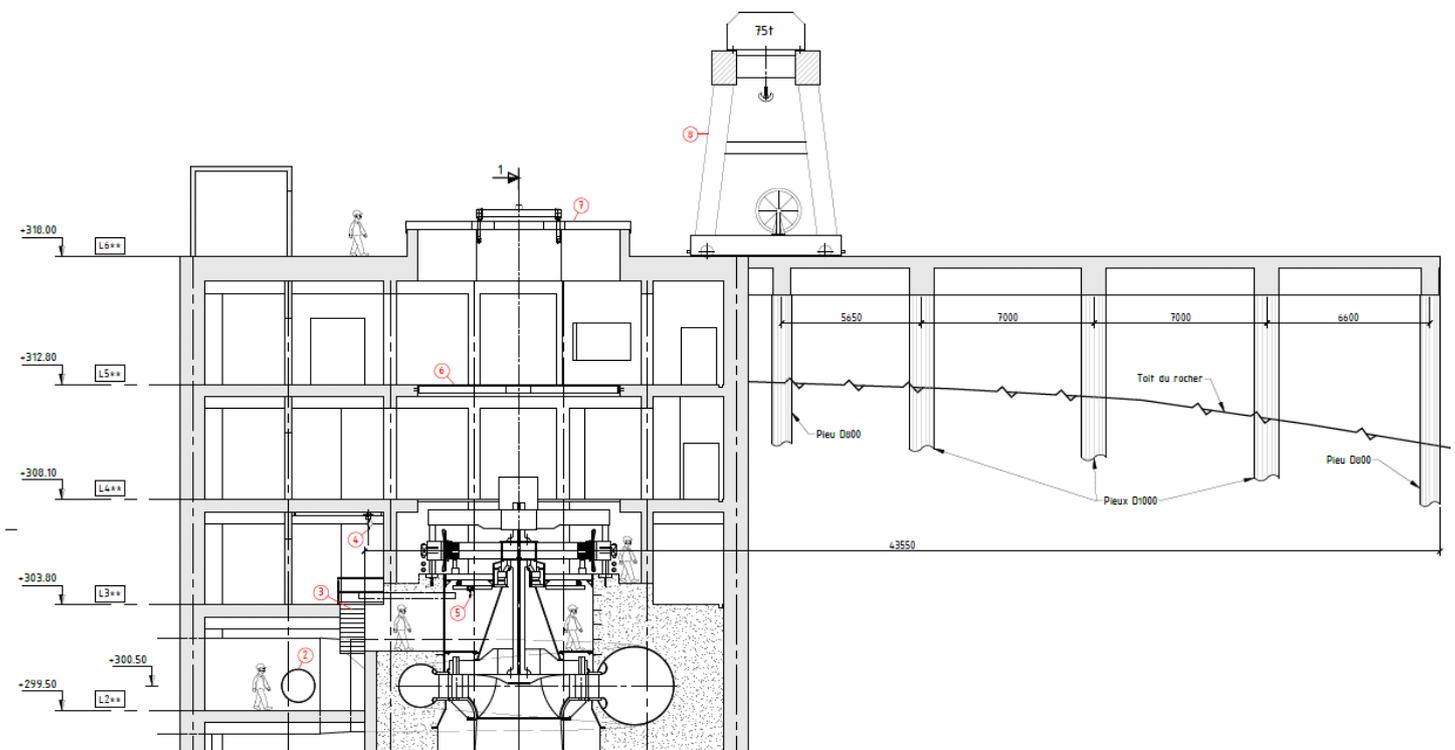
Coupe longitudinale de l'usine sur la plage de montage principale
